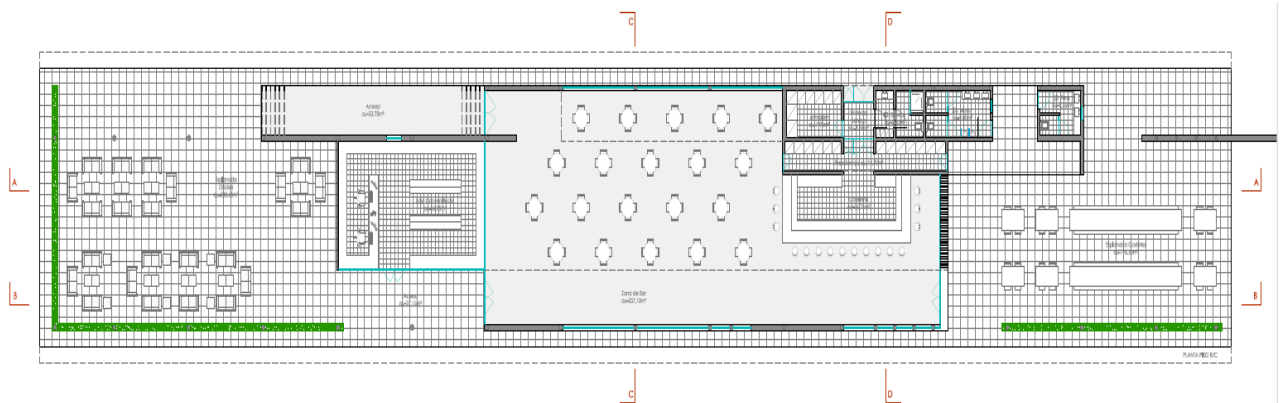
Planta do Piso 0 da Cafeteria/Bar ISTM
